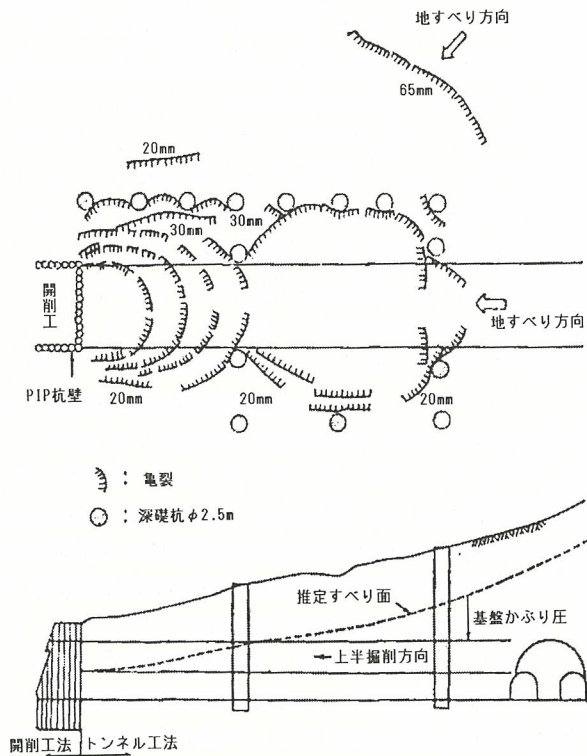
上り線西坑口部の平面図と縦断面¹⁵⁾
